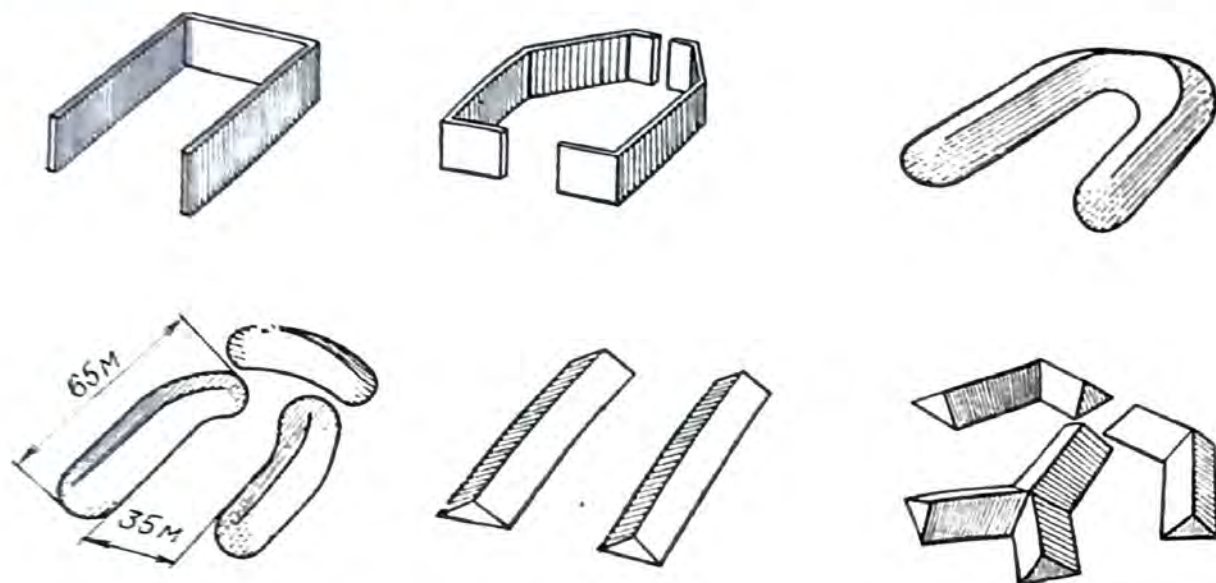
Открытые защитные сооружения для самолетов из металлических или железобетонных блоков и земляных валов
